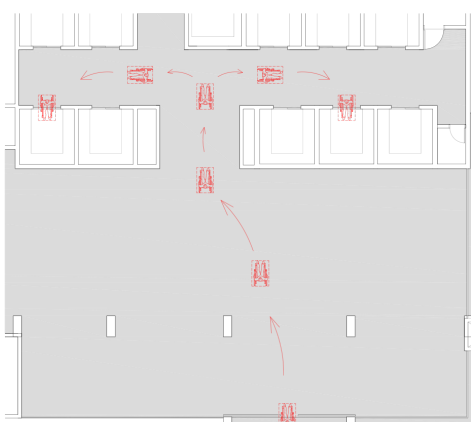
Barreira encontrada na área de descanso do pavimento térreo. Fonte: autora
